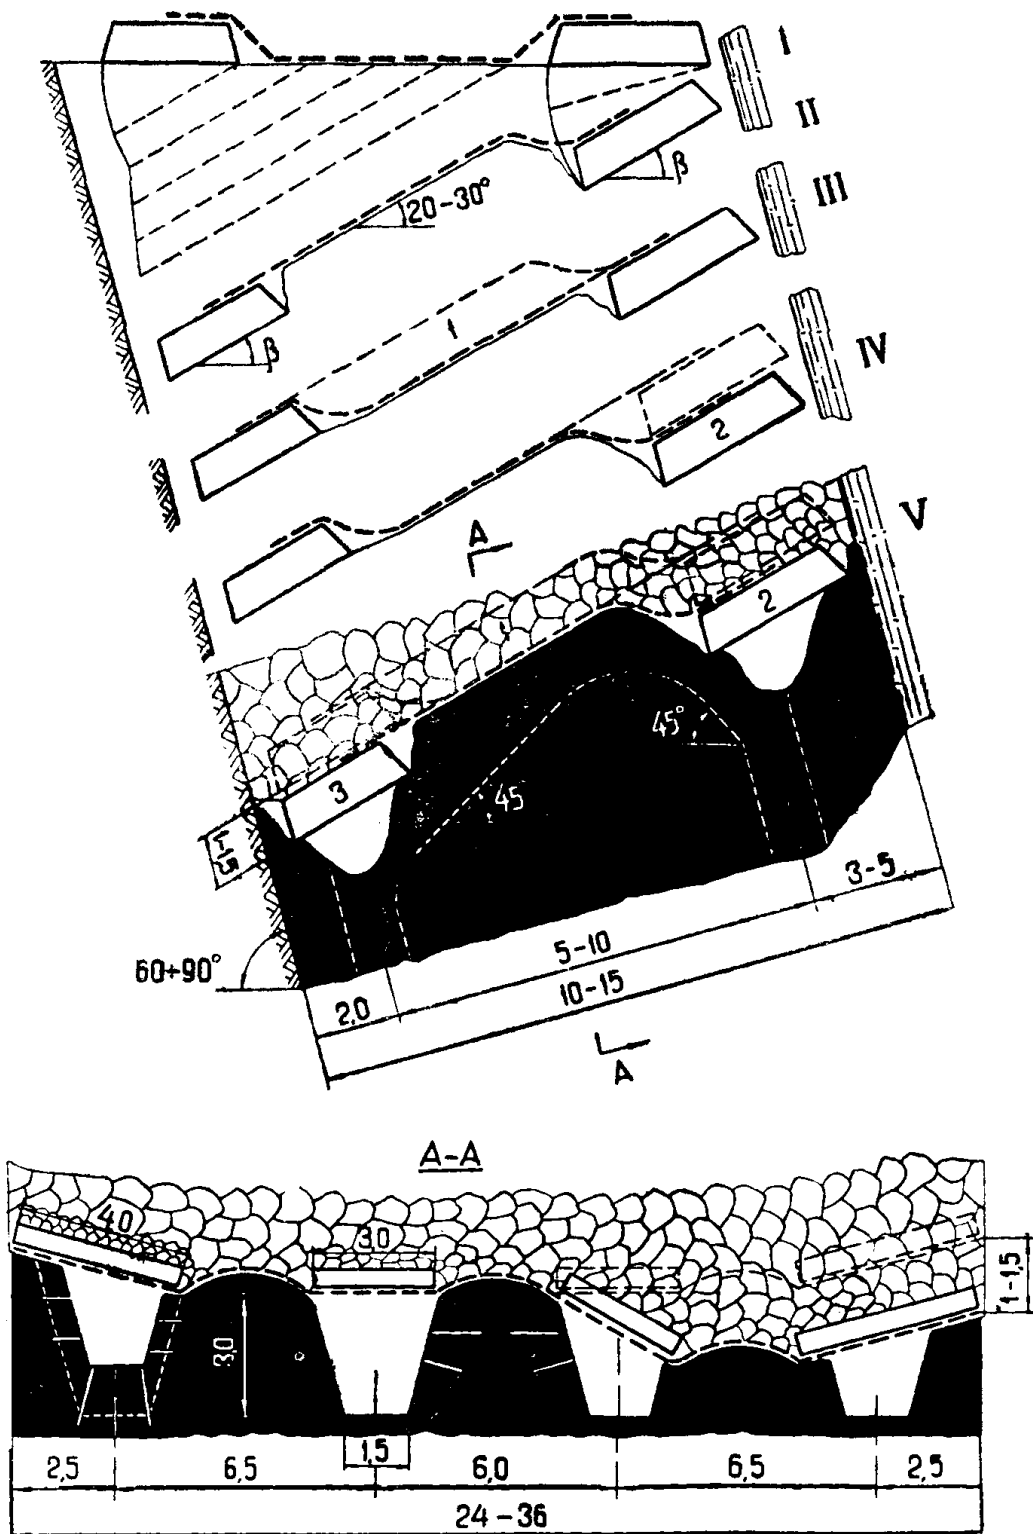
Управление перекрытием в односкатном забое с наклоном к почве пласта при выемке угля в межщитовой толще полосами вкрест простирания пласта
